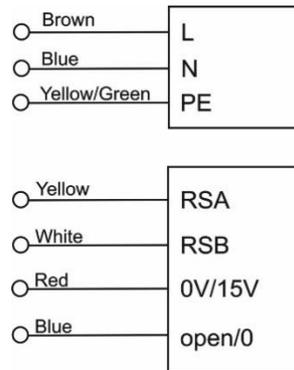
Кабельные соединения двигателя с вентилятором для агрегата VVS005s
